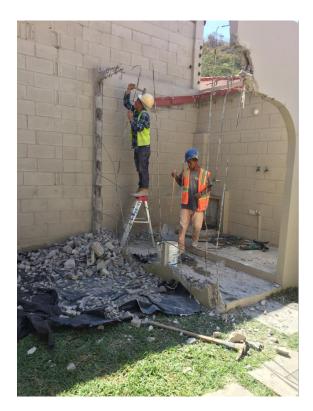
Demolición de pared de 3.05x 3.10 m.
